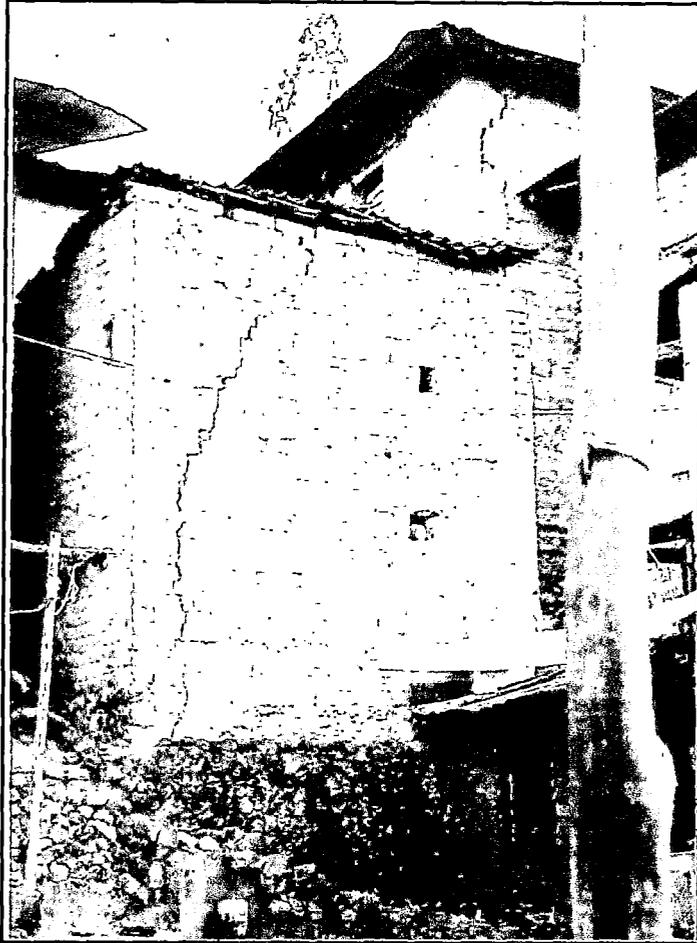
Muros fallados por corte. Las calles estrechas y muros frágiles incrementan la vulnerabilidad de Congas.
